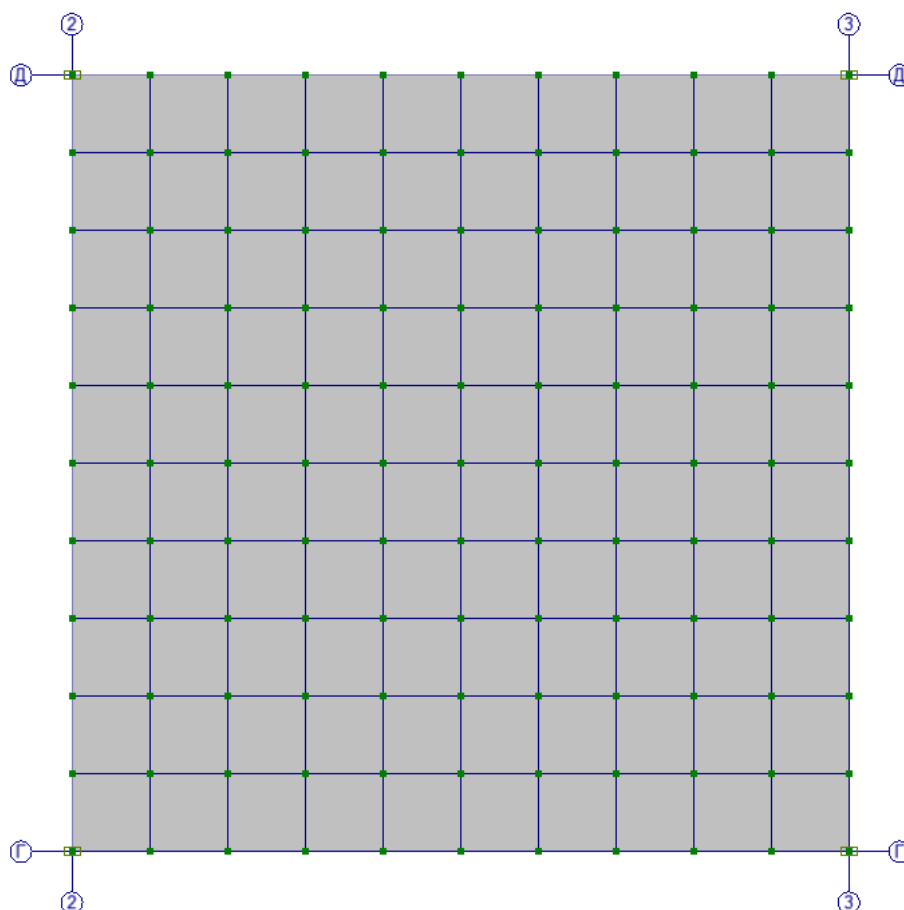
Расчетная схема плиты перекрытия в плоскости
